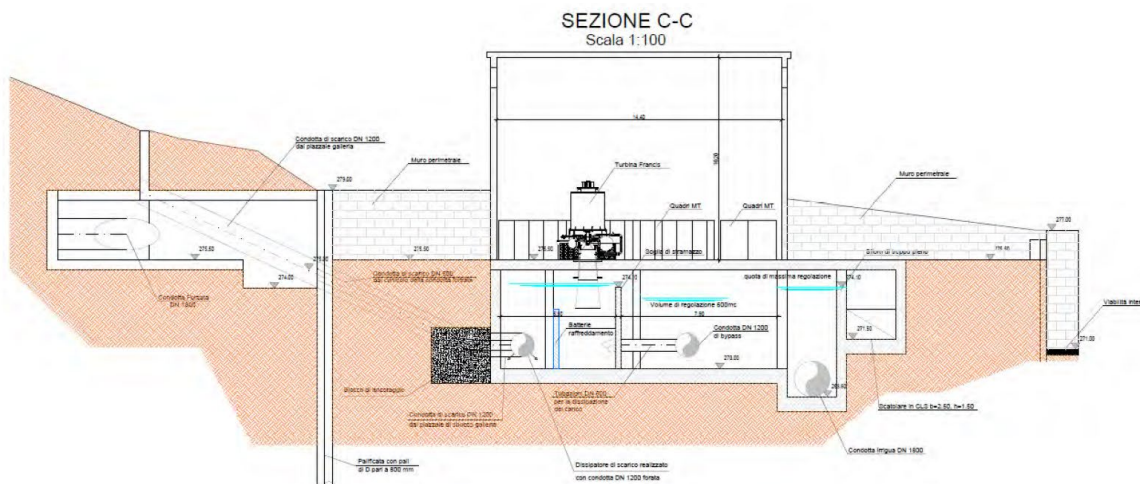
Sezione dell'edificio dell'impianto idroelettrico
